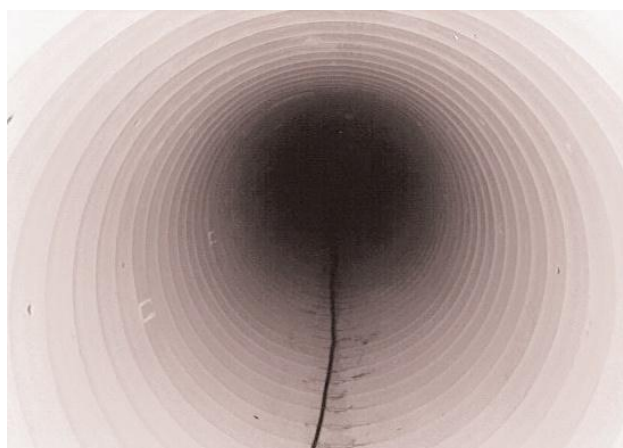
Aspecto Final do Revestimento em Espiral [13]
